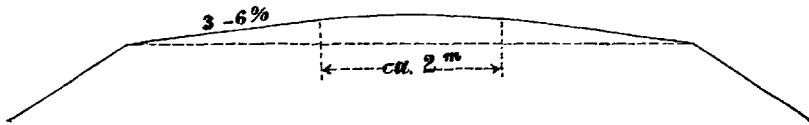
Dachförmiger Querschnitt mit Abrundung.
